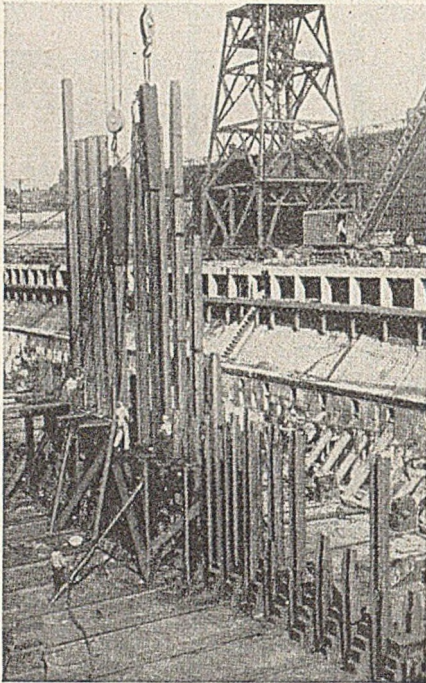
Rammung der Stahlpfähle unter dem Mittelfundament.
